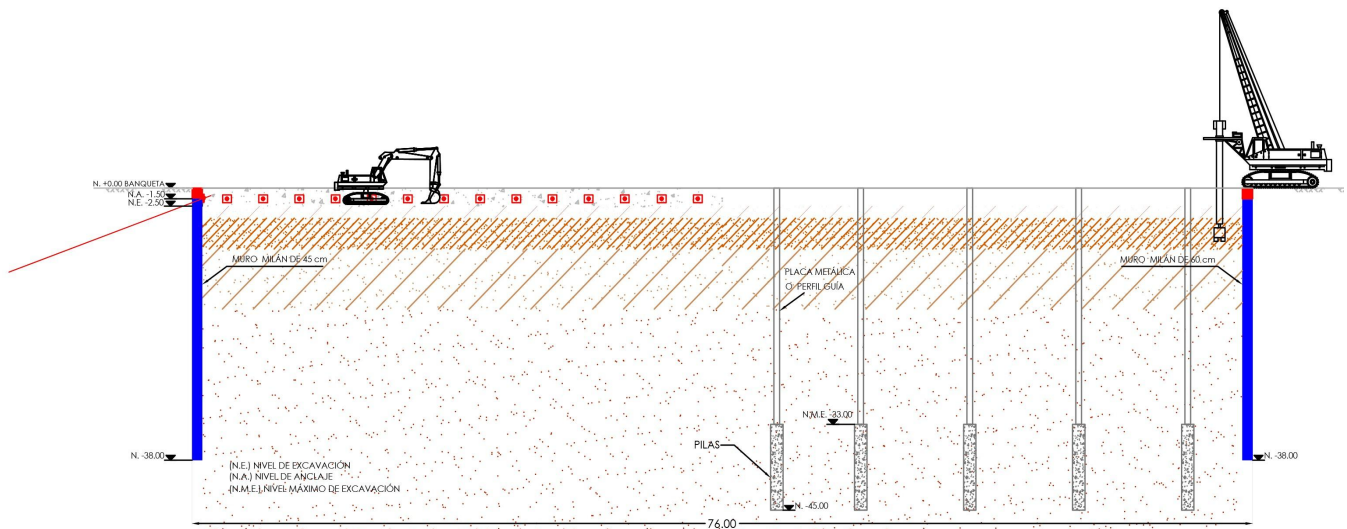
Excavación para ejecución del 1er nivel de anclaje y construcción de pilas.
